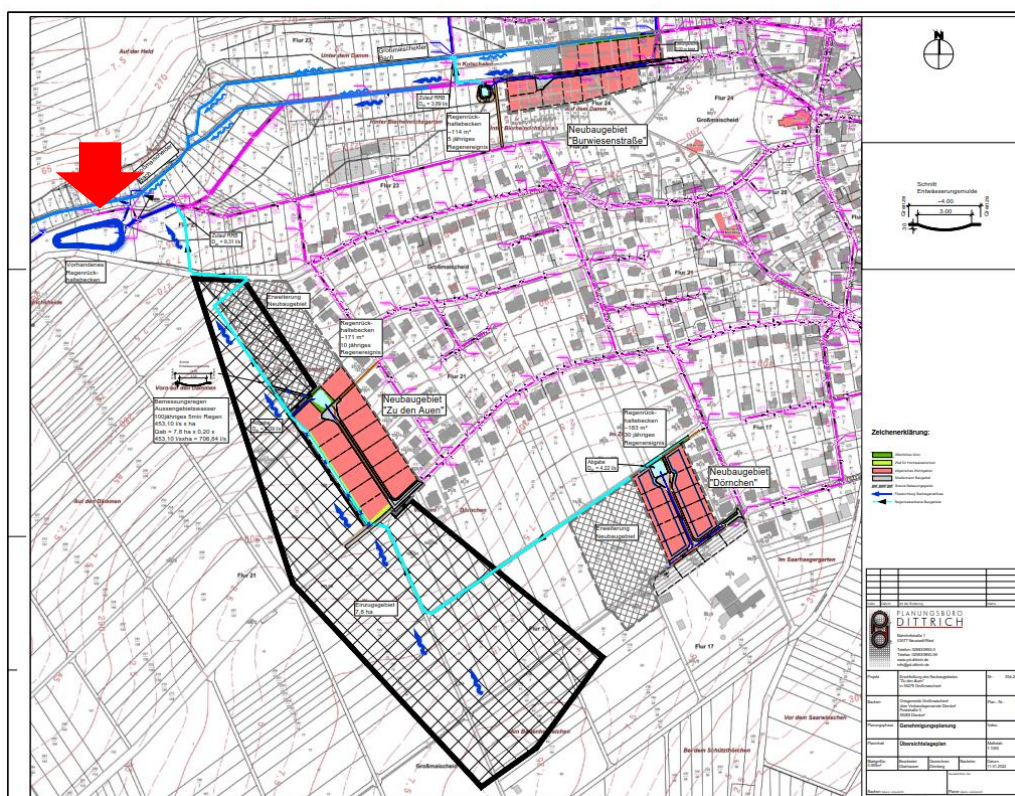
Lageplan mit Kennzeichnung des RRB „Großmaiseid“ (roter Pfeil)
